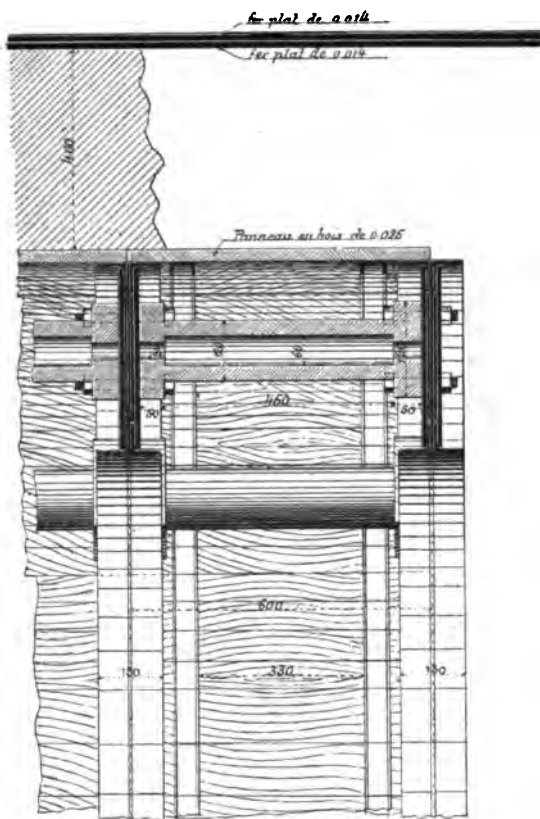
Cintres et entretoises. Coupe longitudinale.
